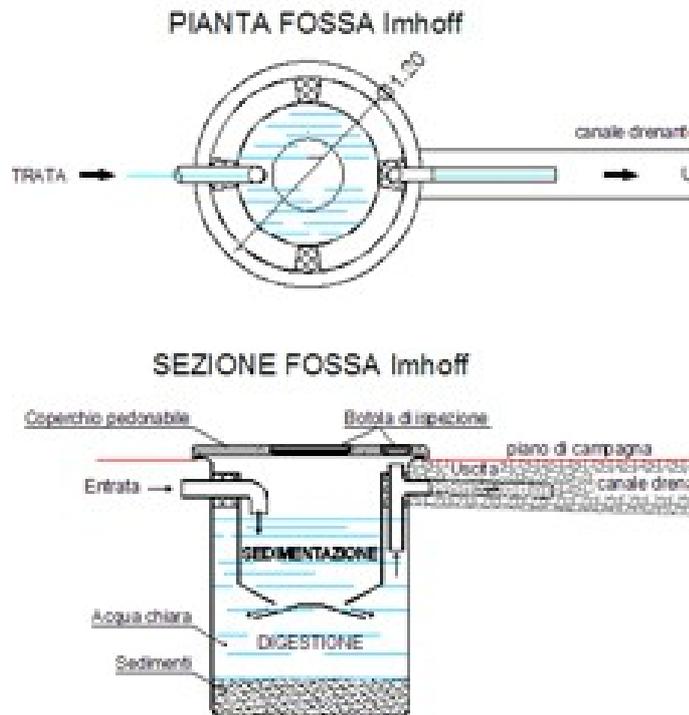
esempio schematico di fossa imhoff (pianta e sezione)
